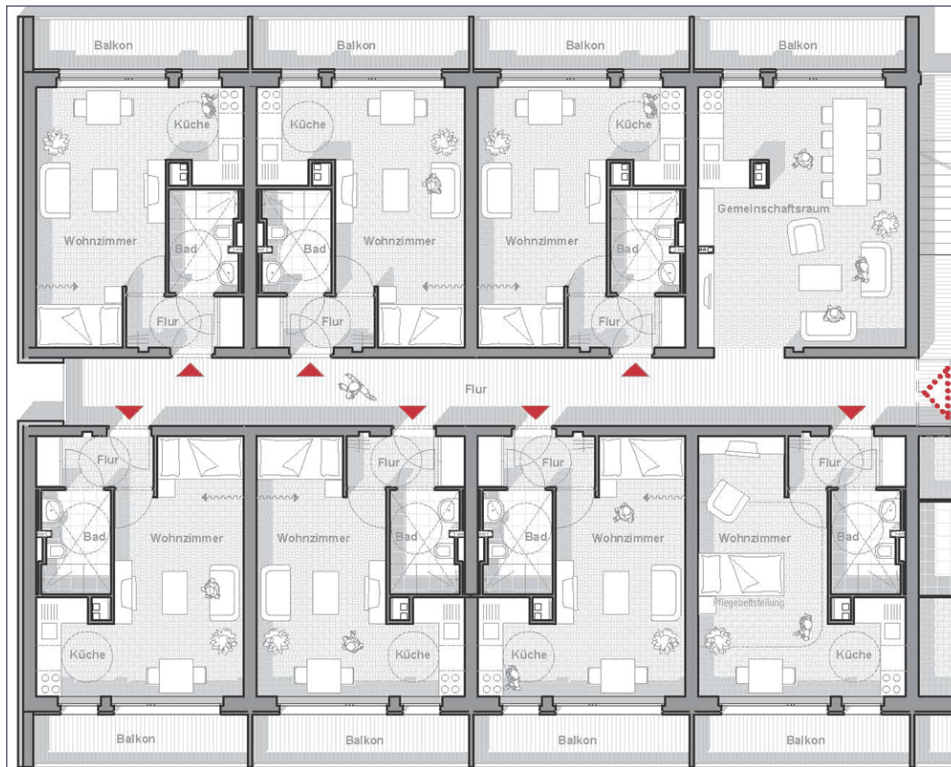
Beispiel-Grundriss von kleinen, bezahlbaren Wohnungen mit Gemeinschaftsraum als Untersuchungsgegenstand des Modellvorhabens (Quelle: GEWOBAg)
